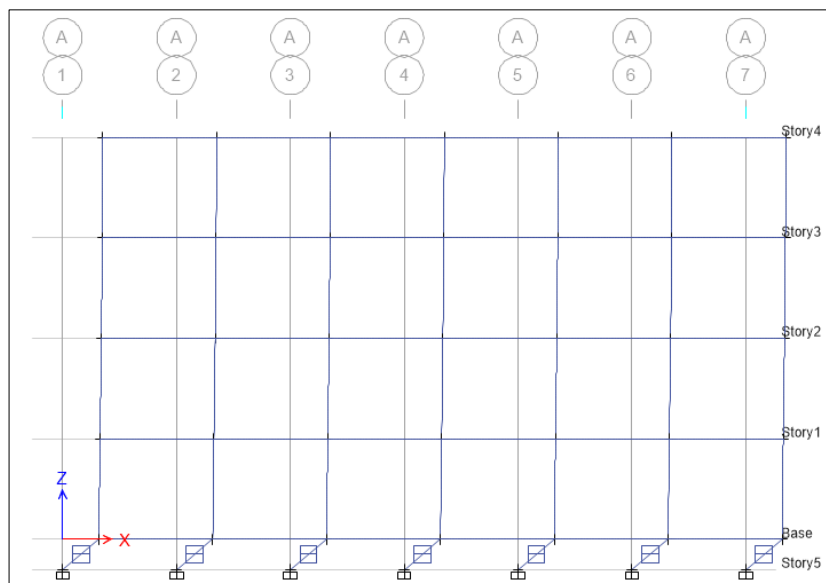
Desplazamiento de la estructura aislada con HDRB en la dirección X
